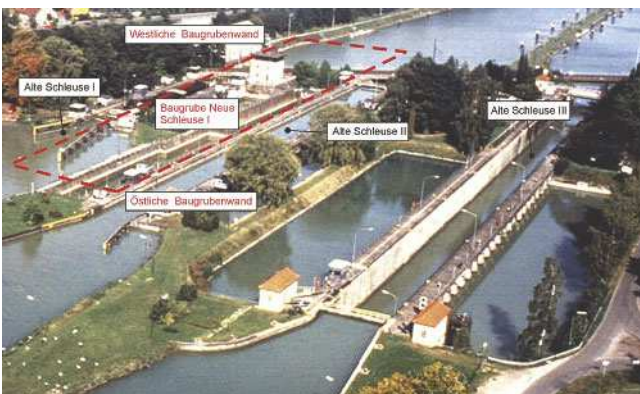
Schleusenanlage Münster mit Lage der Baugrube
